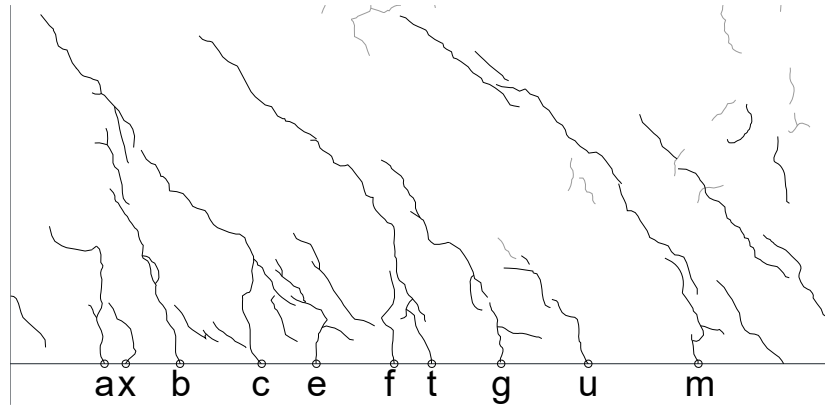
基礎梁ひび割れ幅測定位置(試験体 D-4 正載荷)
